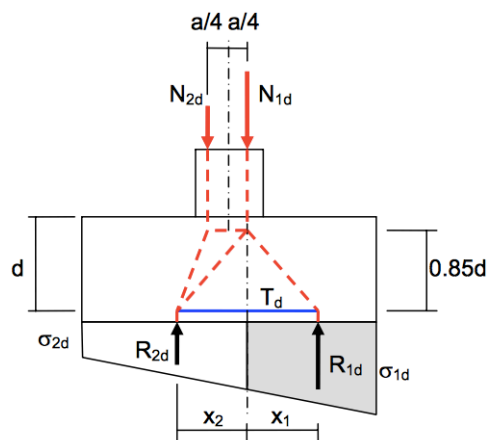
Esquema de cálculo para bielas y tirantes en zapata aislada. [84]
